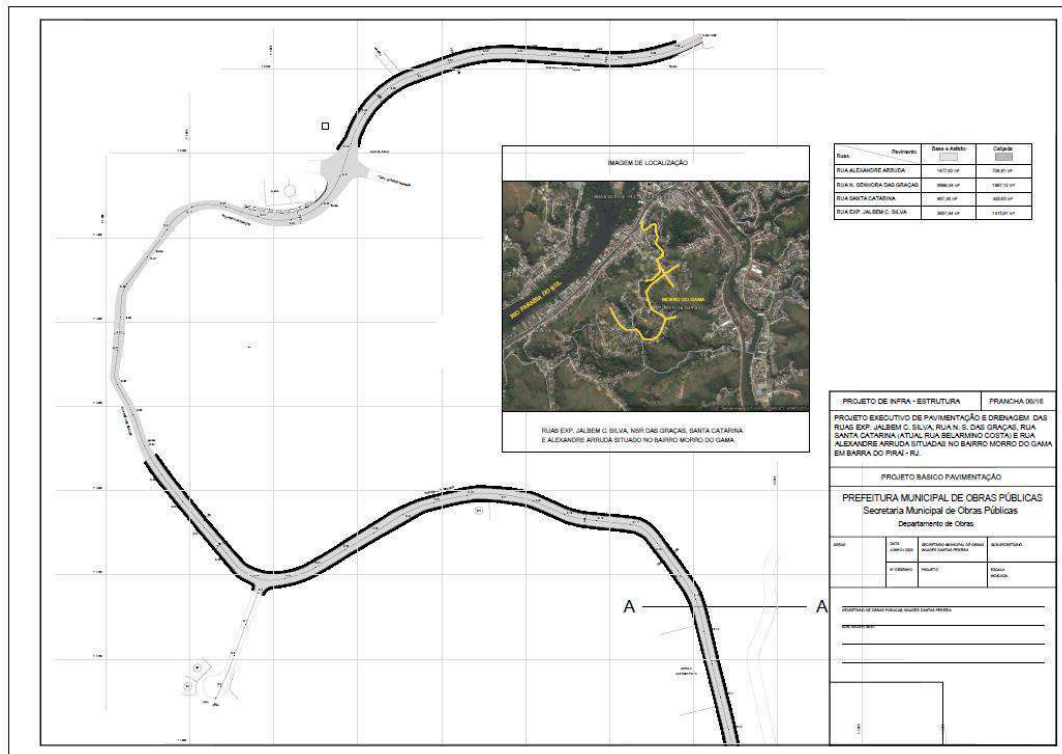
Projeto Básico de Pavimentação (anexo 7)
